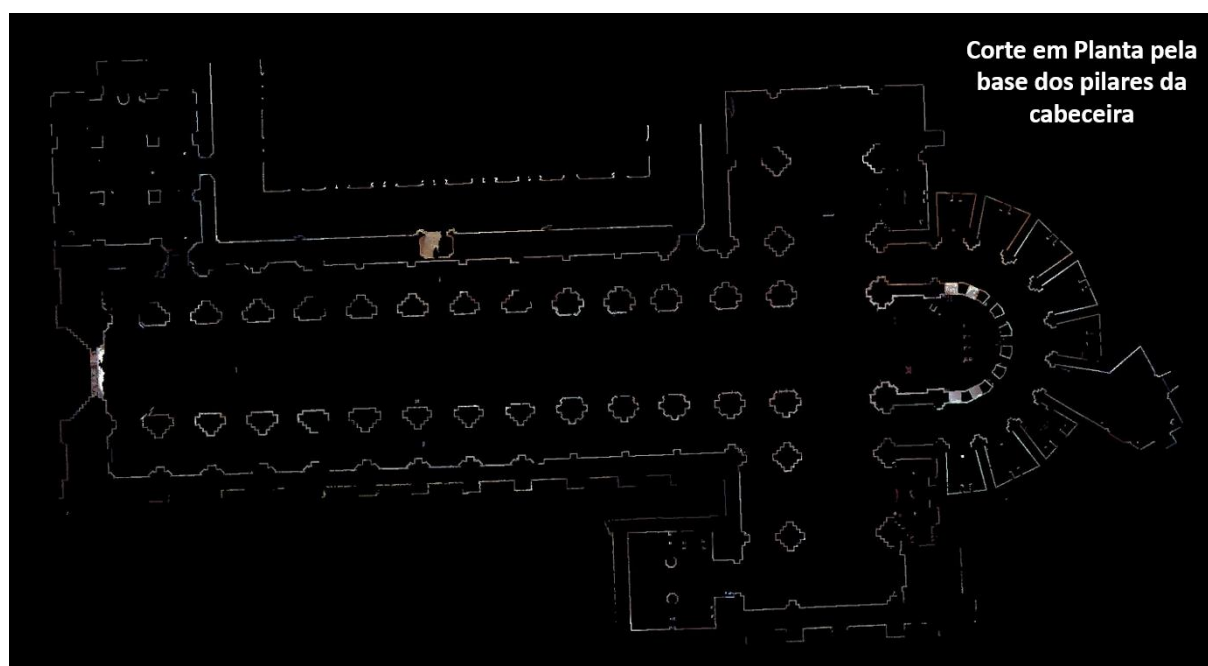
Corte em planta pela base dos pilares da cabeceira da Igreja do Mosteiro de Alcobaça.
